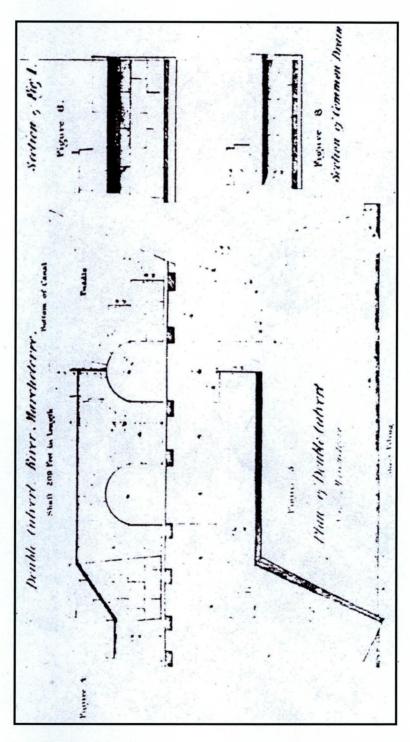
Section du plan « Plan and Sections of the Several Culverts constructed under the Beauharnois Canal ». Collection Georges Howson.
